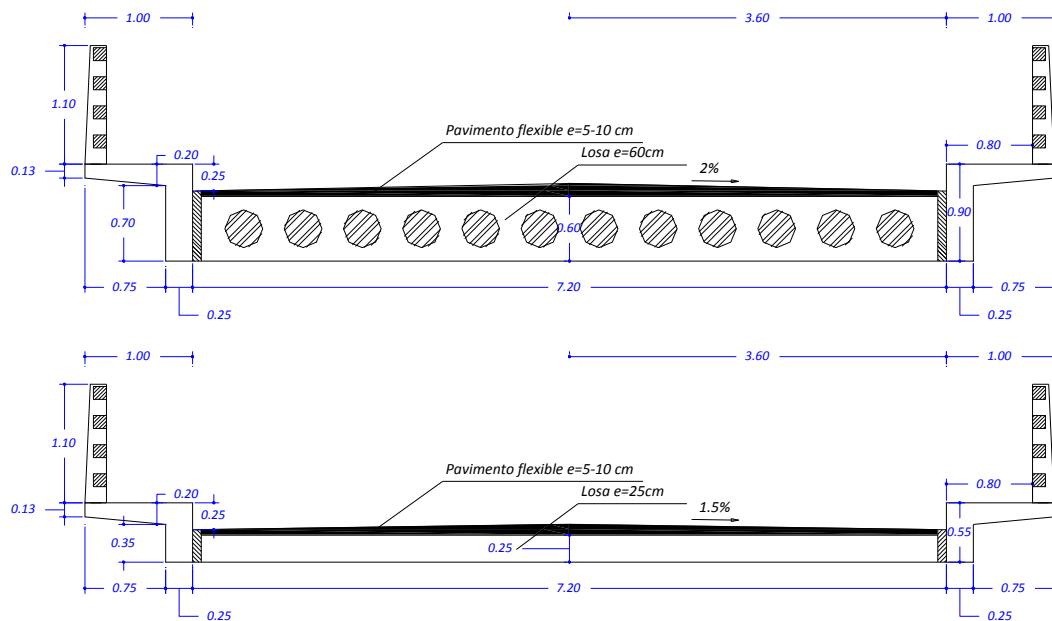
Secciones transversales de los tableros de los puentes losas y arco. (Fuente: Elaboración propia)
